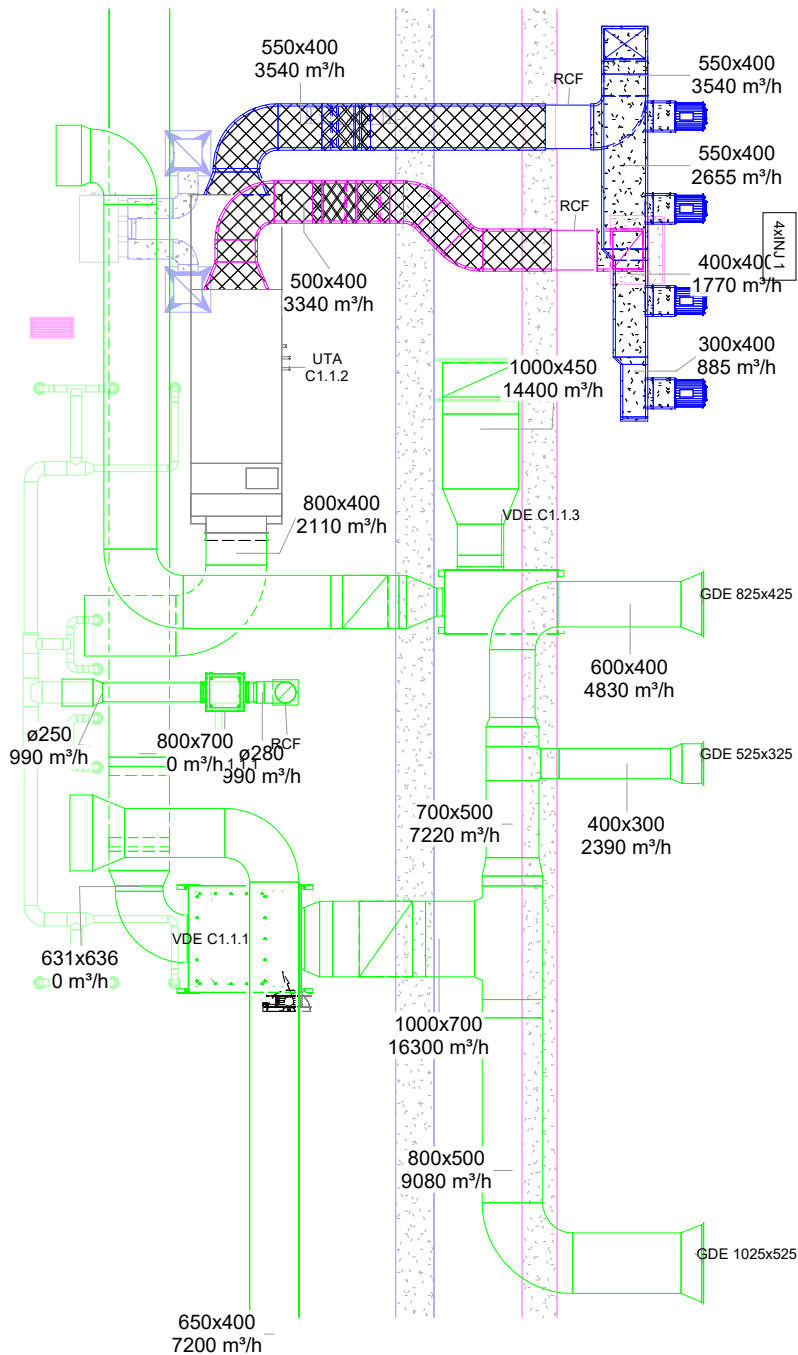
Seção 2.2 da planta geral do traçado das condutas na mezzanine à escala 1:100.
